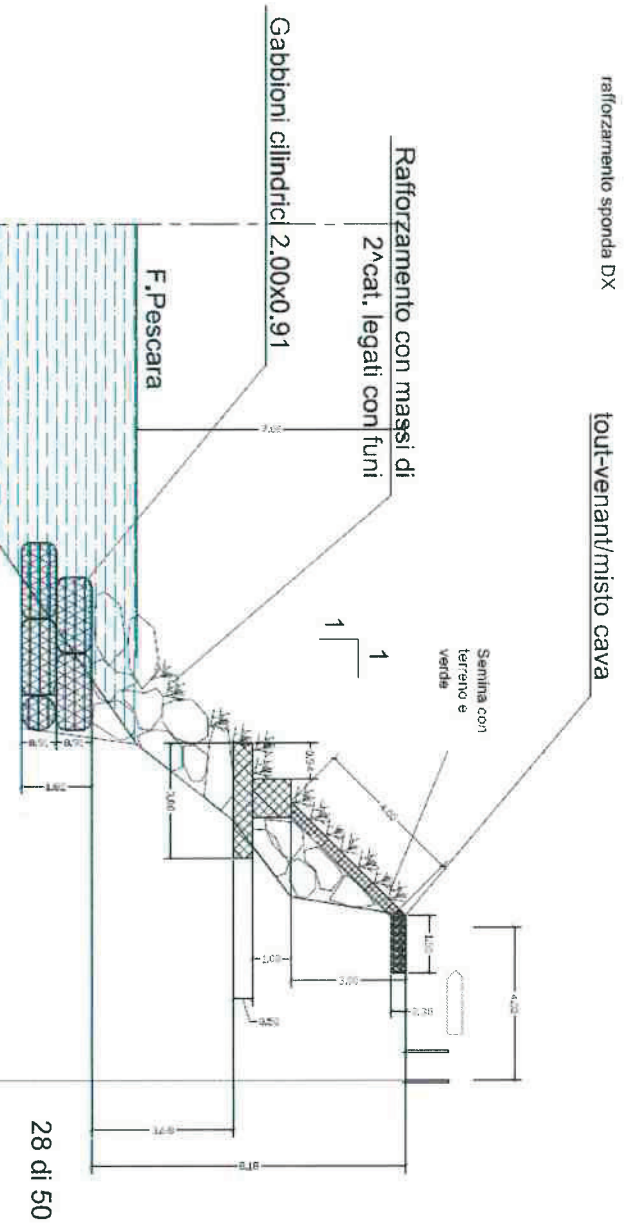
Prospetto tipo opera finita con indicazione degli interventi progettuali previsti.
